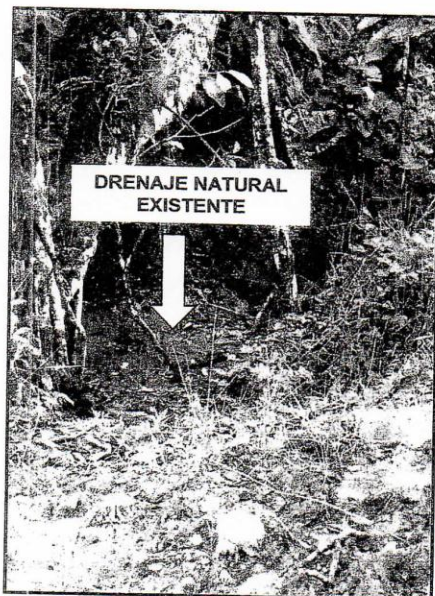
IMAGEN DEL DRENAJE NATURAL EXISTENTE QUE ATRAVIESA PARTE DEL LOTE DONDE SE DESARROLLARÁ EL NUEVO PROYECTO RESIDENCIAL COQUITO GREEN.
